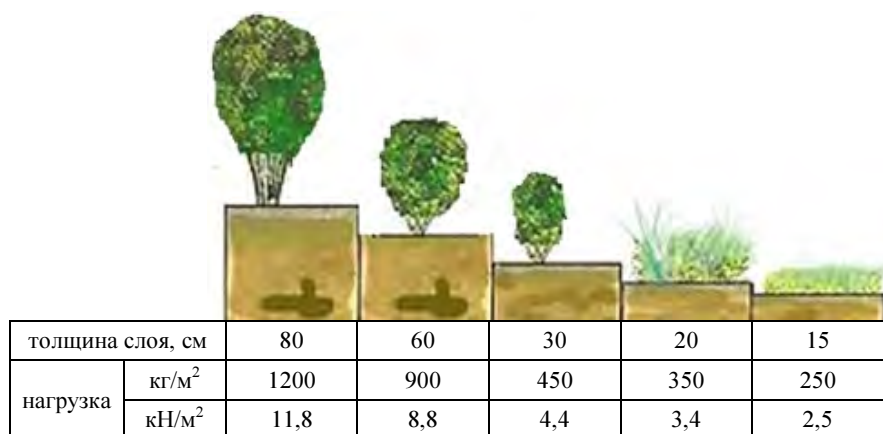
Нагрузки на кровлю при разных толщинах слоя грунта
